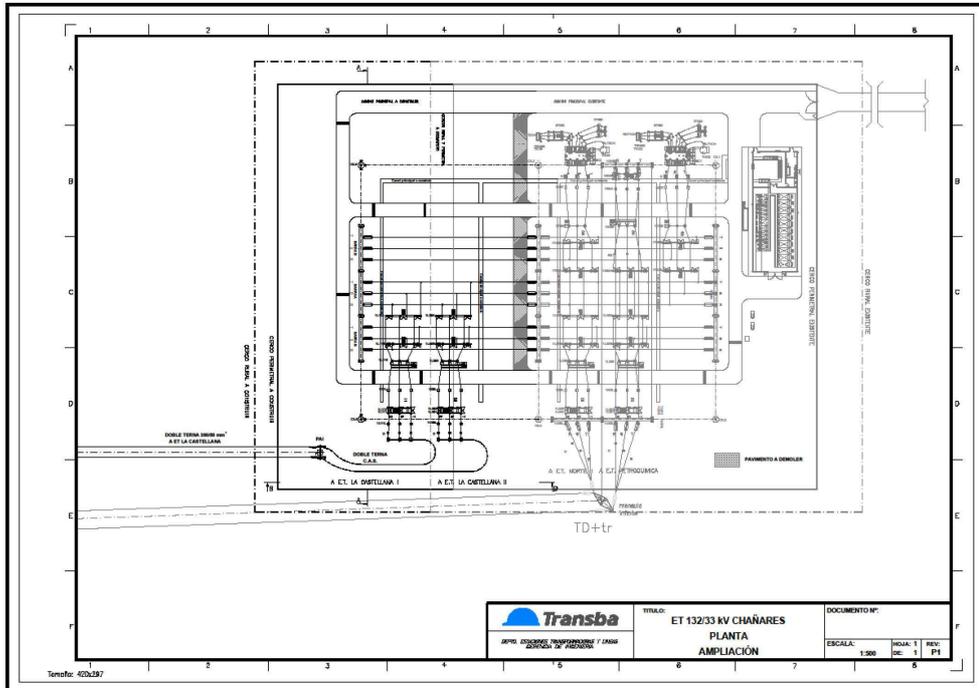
Plano de planta de 132 kV de ET CHAÑARES – ampliación de barra y acometida de líneas
